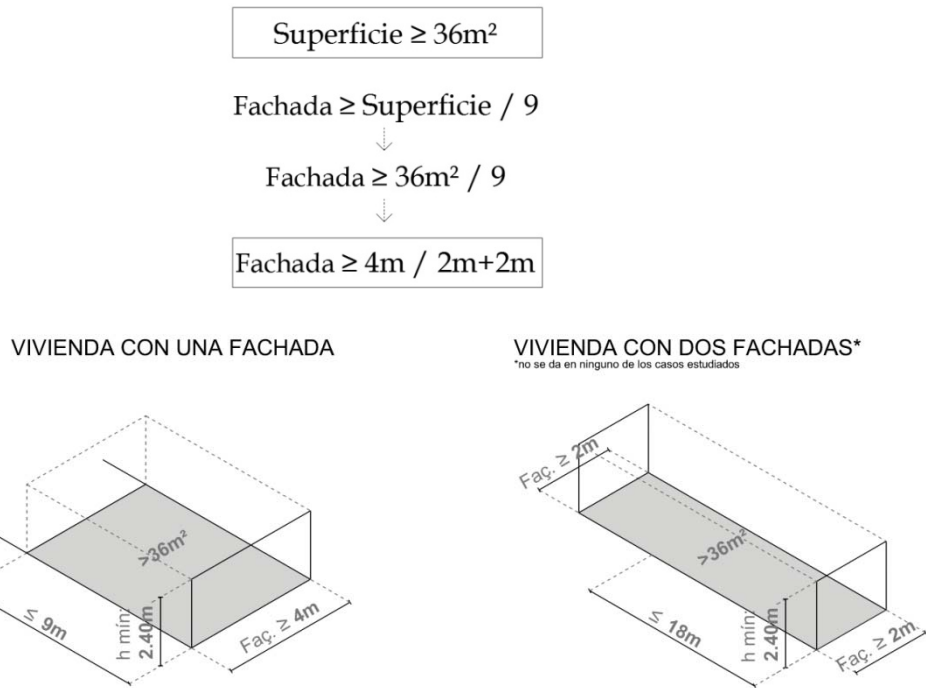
Longitud mínima de fachada en función de si la vivienda es pasante o no. Elaboración propia
